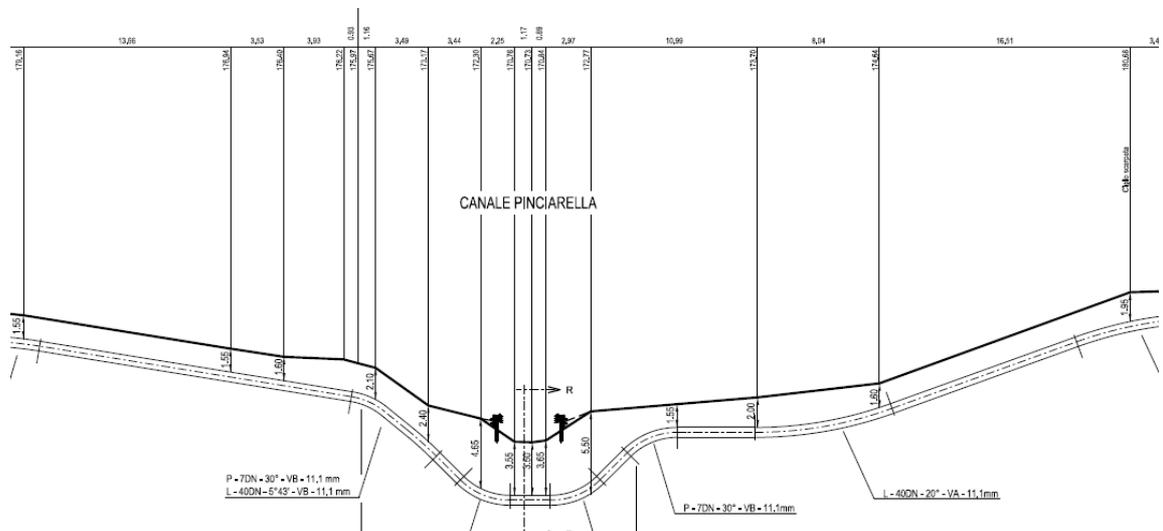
Attraversamento canale Pinciarella - Sezione schematica di progetto
